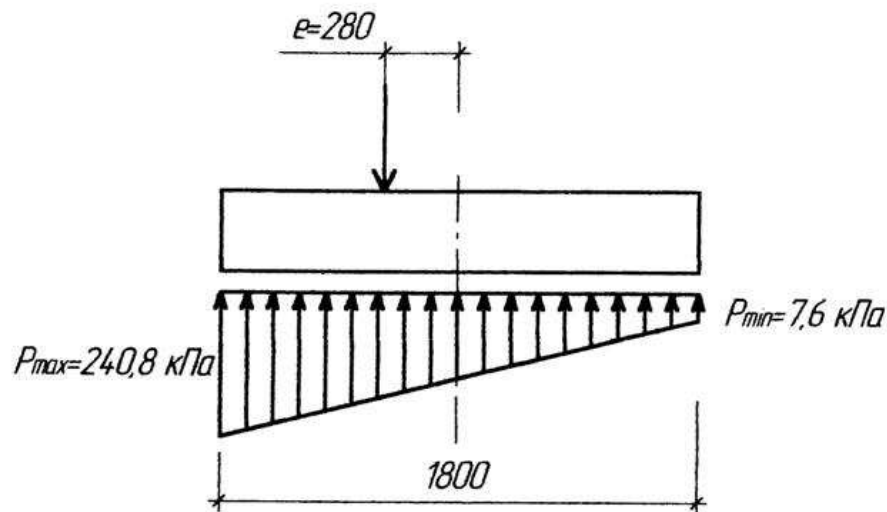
Епюра тиску під подошвою фундаменту під колону крайнього ряду
